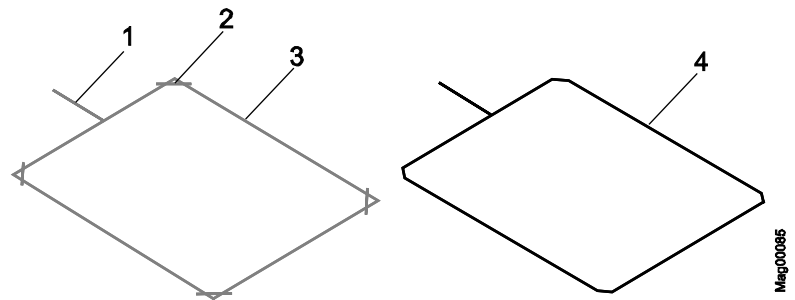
Placera induktionsslingor i bitumen, asfalt eller betong
